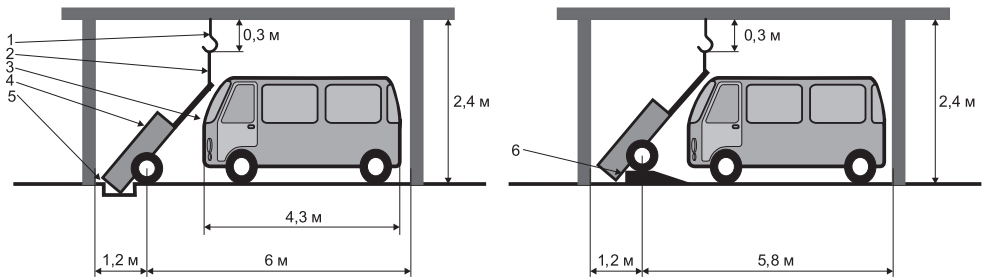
Примеры расположения автомобиля и прицепа в одном гараже: 1 — металлический крюк; 2 — веревка; 3 — автомобиль; 4 — прицеп; 5 — канавка; 6 — уступ
